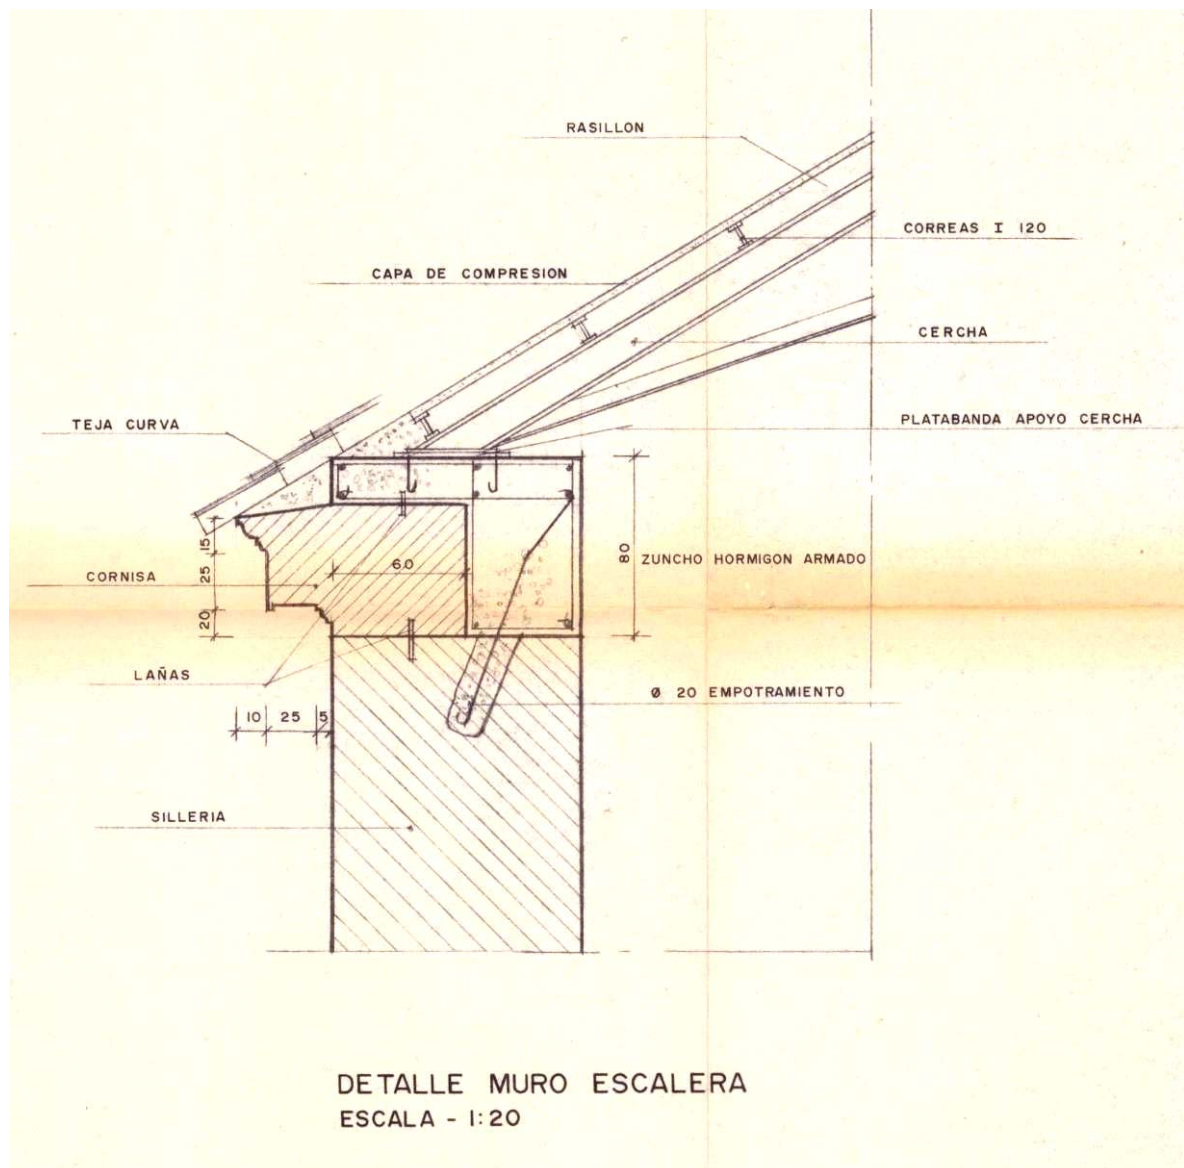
Detalle. Zuncho de hormigón armado que se empotra por el lado interior del muro y se une a él mediante un redondo empotrado el mismo. Sobre éste apoya la cercha de la cubierta. 1980.
